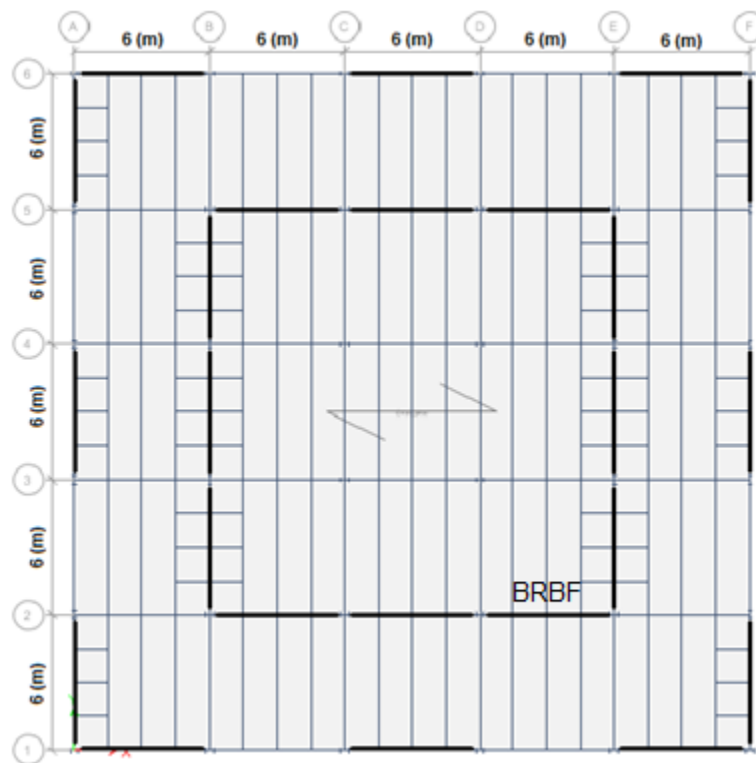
Vista en planta de la edificación de 5 niveles.
